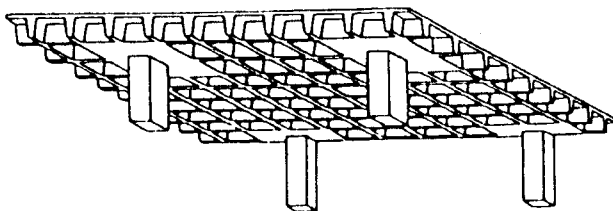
Laje-cogumelo nervurada (NEVILLE, 1983)
